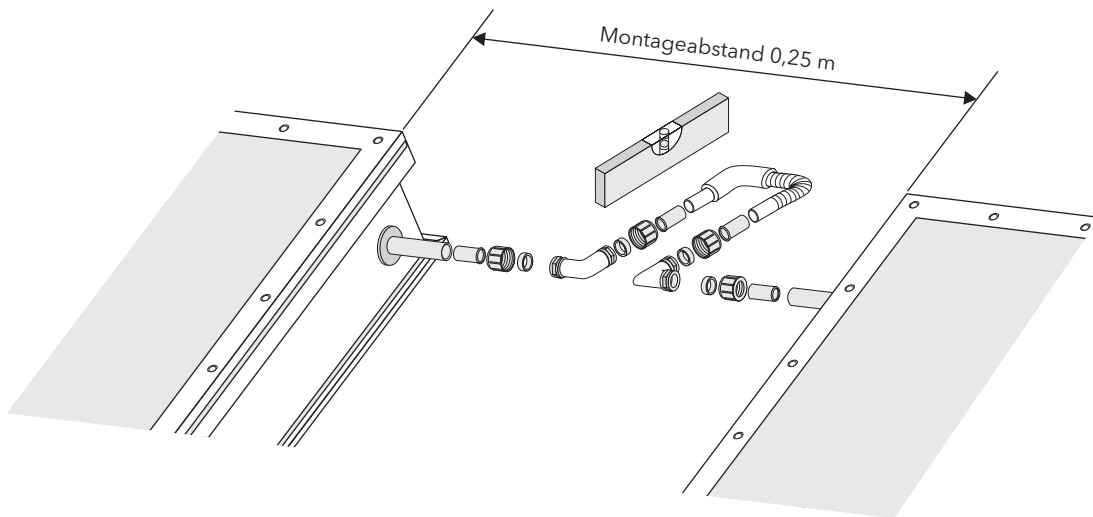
Kollektorverbindung mit Klemmringverschraubung
